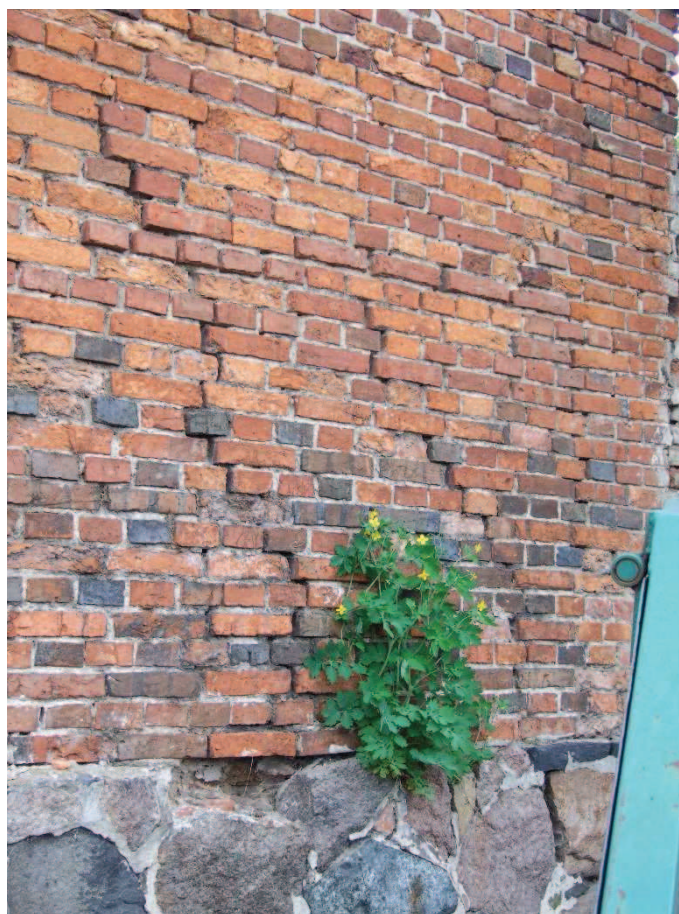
Mur A - południowy koniec muru nad przepustem, widoczne pionowe zarysowanie i skrajna przypora muru pozbawiona fundamentu.
